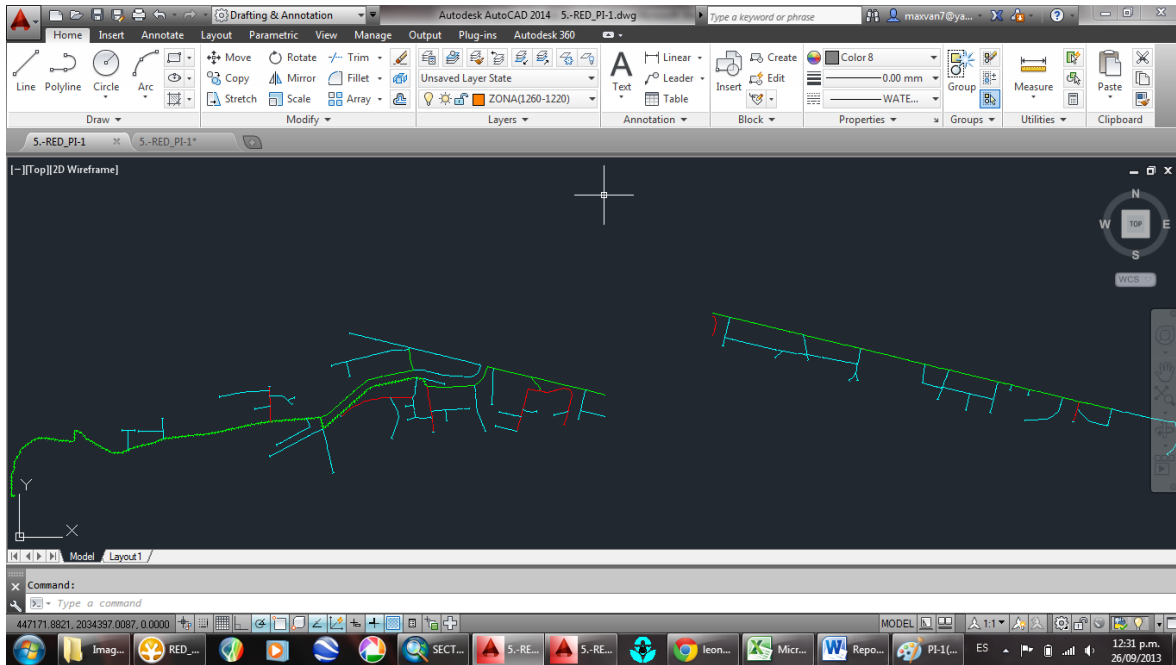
Plano de la red que comprende el sector PI-1
